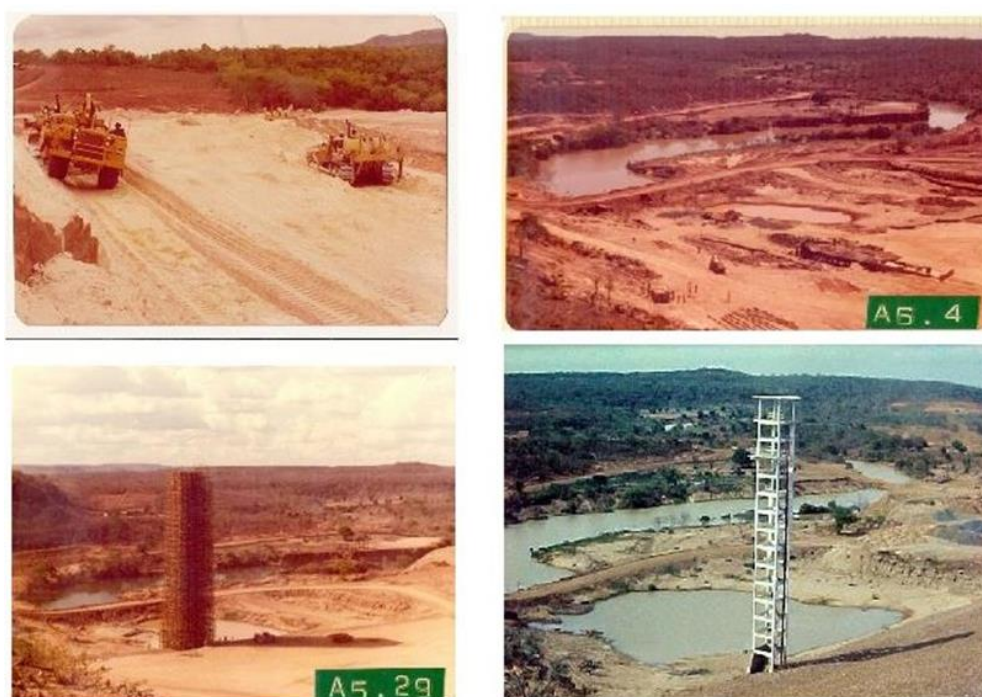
Construção da Barragem de Bocaina, Piauí.
